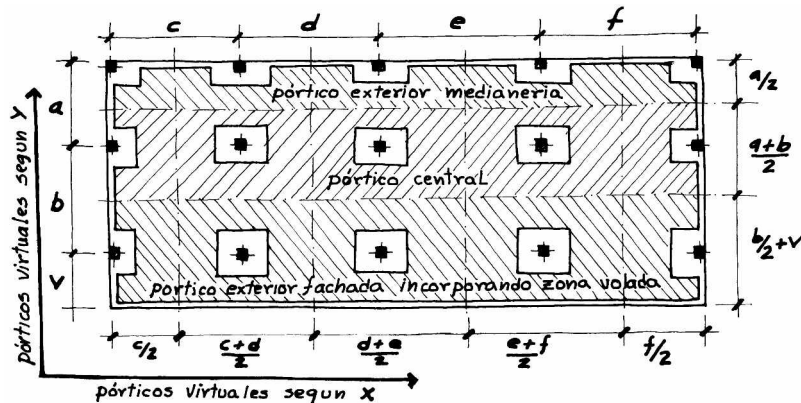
Planta básica y ancho de las vigas que deberían considerarse en la materialización de los pórticos virtuales o de sustitución.
